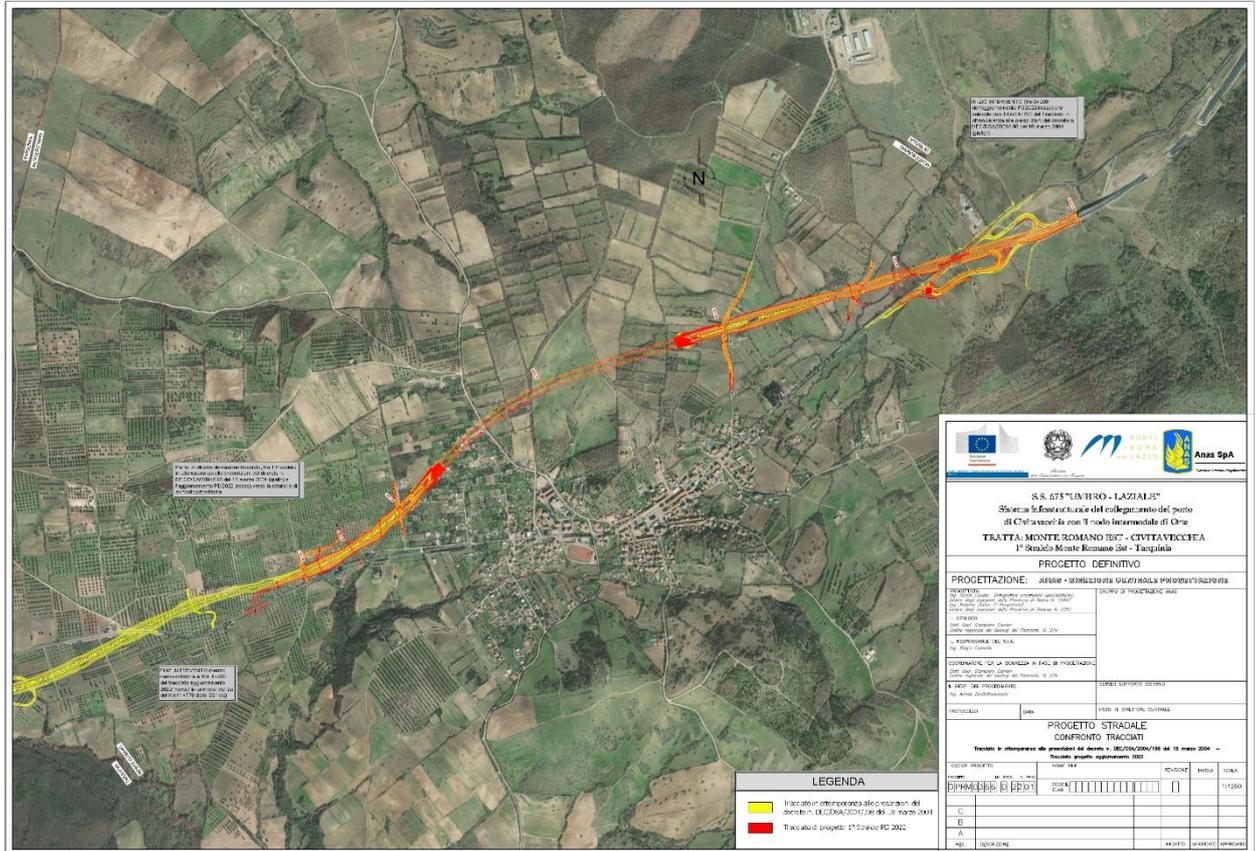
Confronto tracciato Approvato Commissione VIA 2008 e progetto attuale
